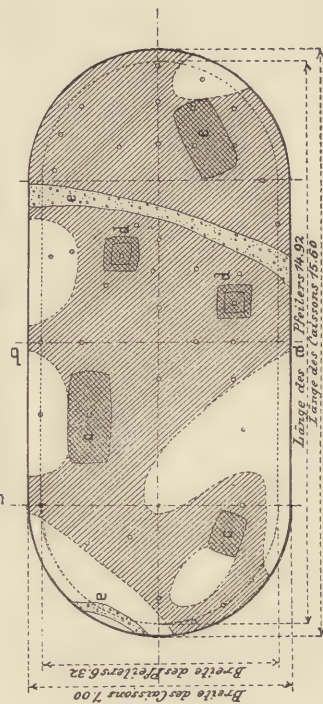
Grundriss des 2^{ten} Pfeilers
